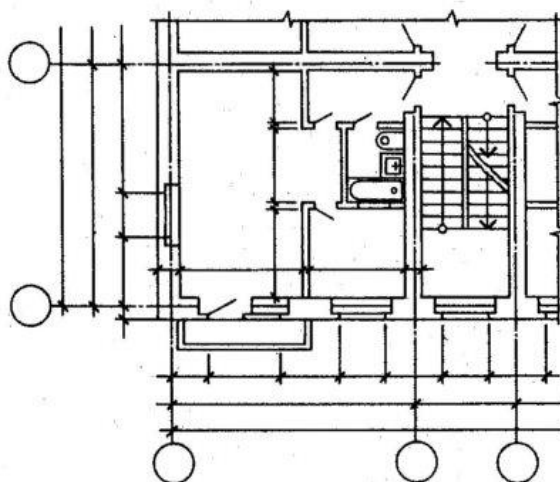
Нанесение оконных и дверных проёмов, лестниц и площадок
